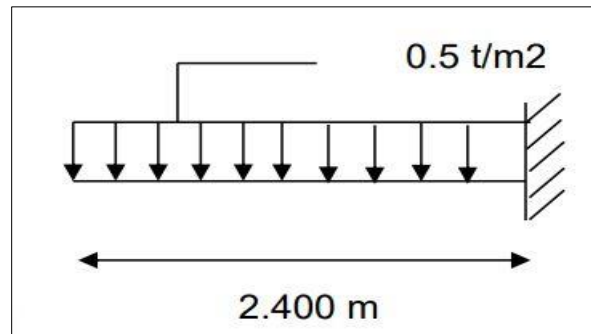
Dalles En Encorbellement Sous la surcharge du trottoir
